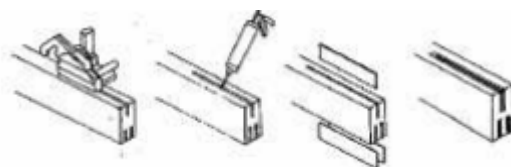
Representação esquemática da aplicação de reforço de elementos de madeira com armaduras longitudinais (Antigos, 2007b)
